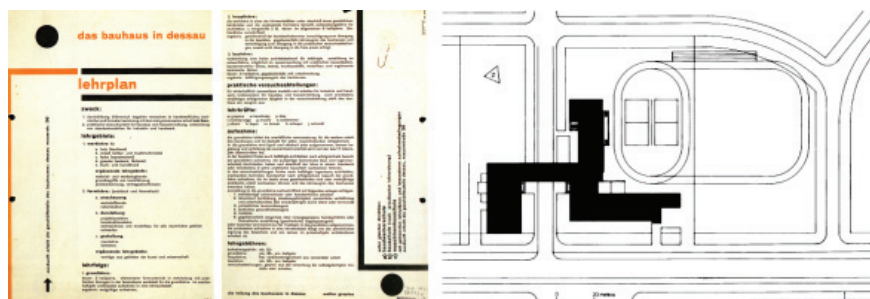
Walter Gropius: Pla d'estudis de la Bauhaus i planta de l'edifici. Dessau, 1925.
